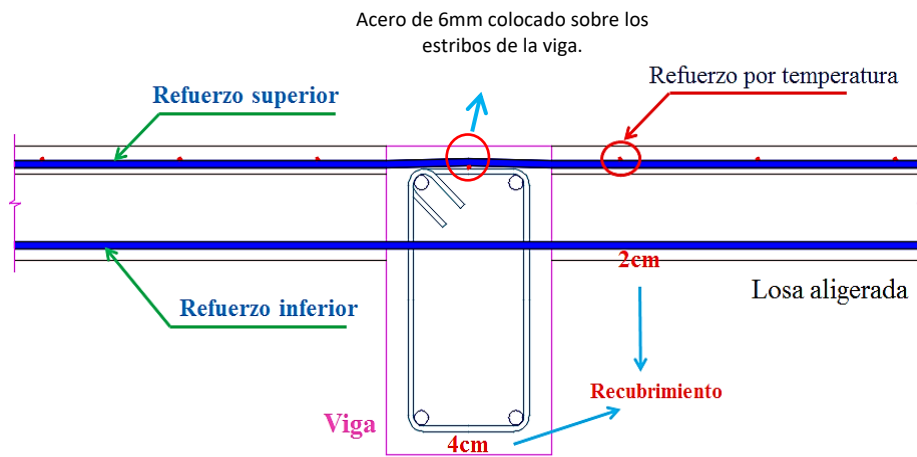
Detalles adicionales del refuerzo en losas aligeradas unidireccionales
